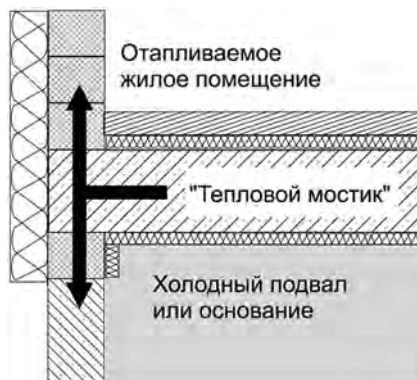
«Тепловой мостик» в месте стыка наружной стены с подвальным перекрытием и подвальной стеной или с плитой основания и фундаментной стеной
